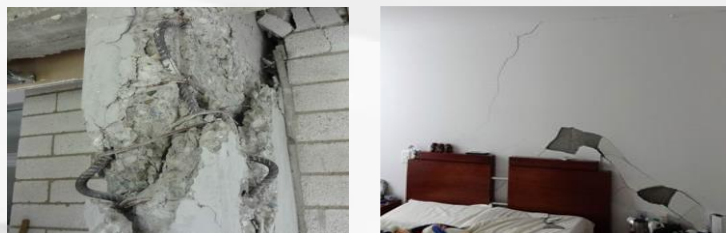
Falla en columna y muros fisurados de la etapa 6, edificio Space.
